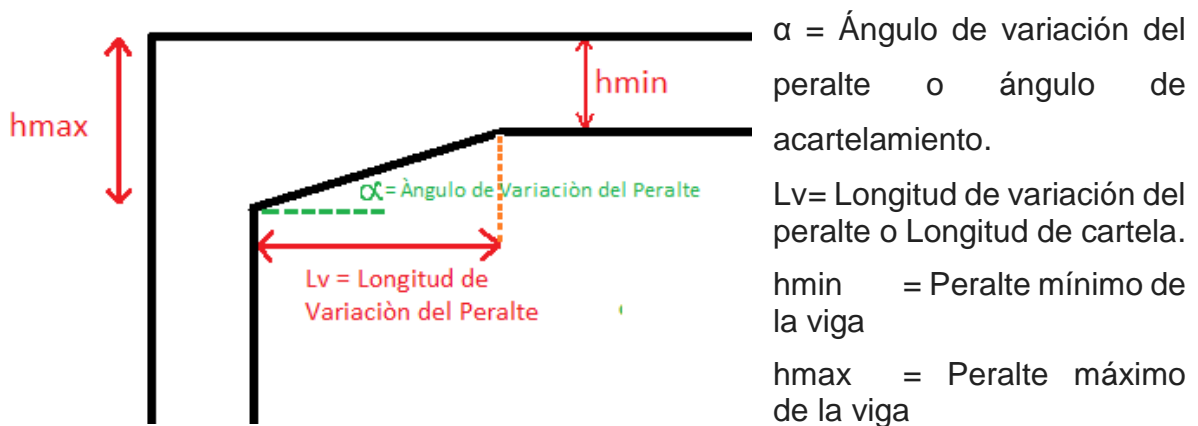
4 Dimensiones de un pórtico con vigas de sección variable
